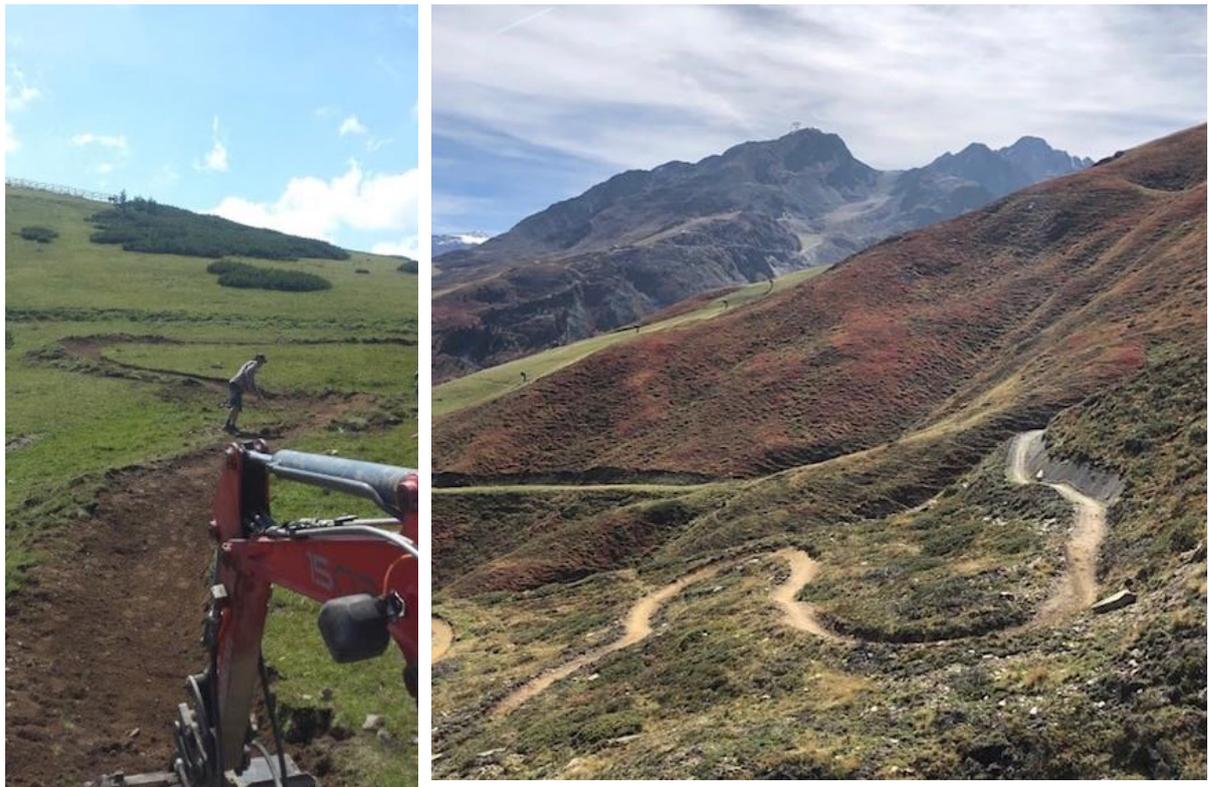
Baudurchführung bei einem ähnlich gelagerten Projekt (links) – fertiggestellte Bike-Trasse (rechts)
